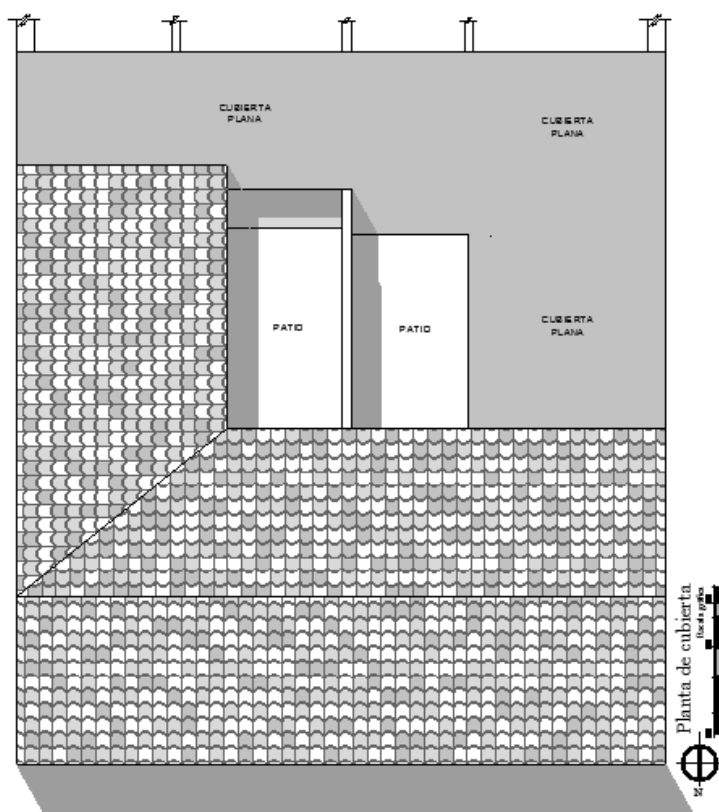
Croquis de planta cubiertas de la vivienda Abad. Fuente: J. J. Segura Granados.
